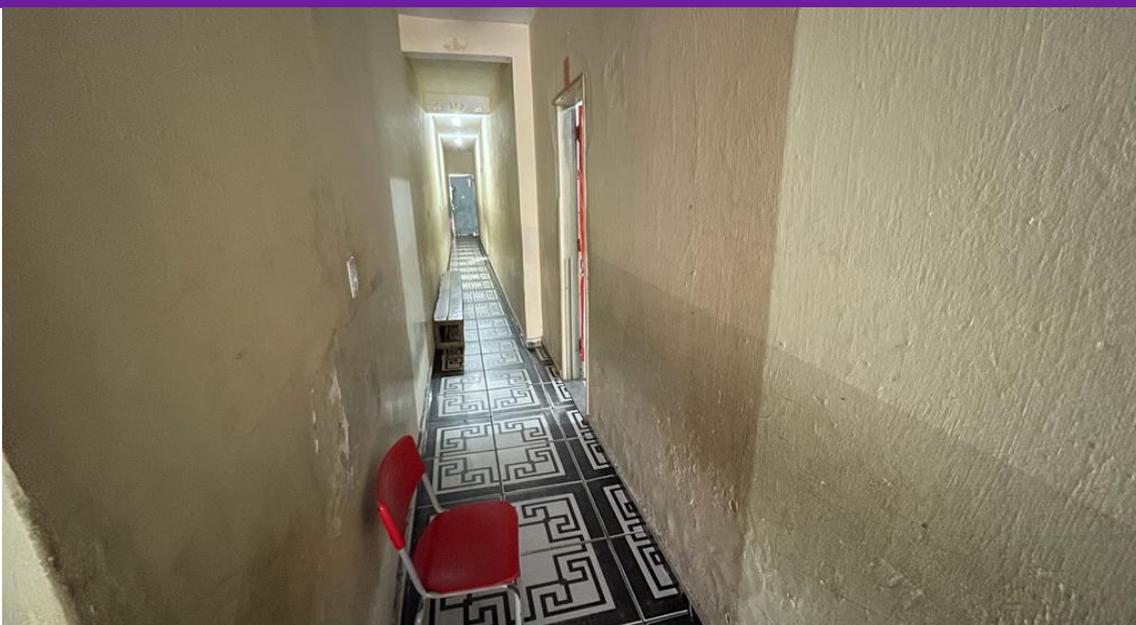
Corredor de acesso pavimento térreo, revitalização de pintura (Proprietário);
